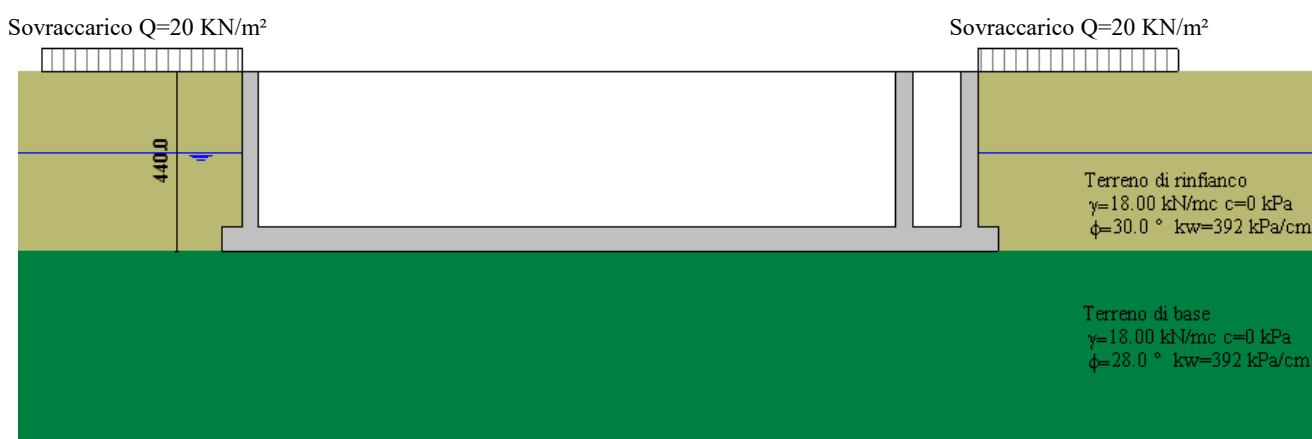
Modello geotecnico e strutturale, sezione longitudinale di maggior altezza dell'opera di derivazione
